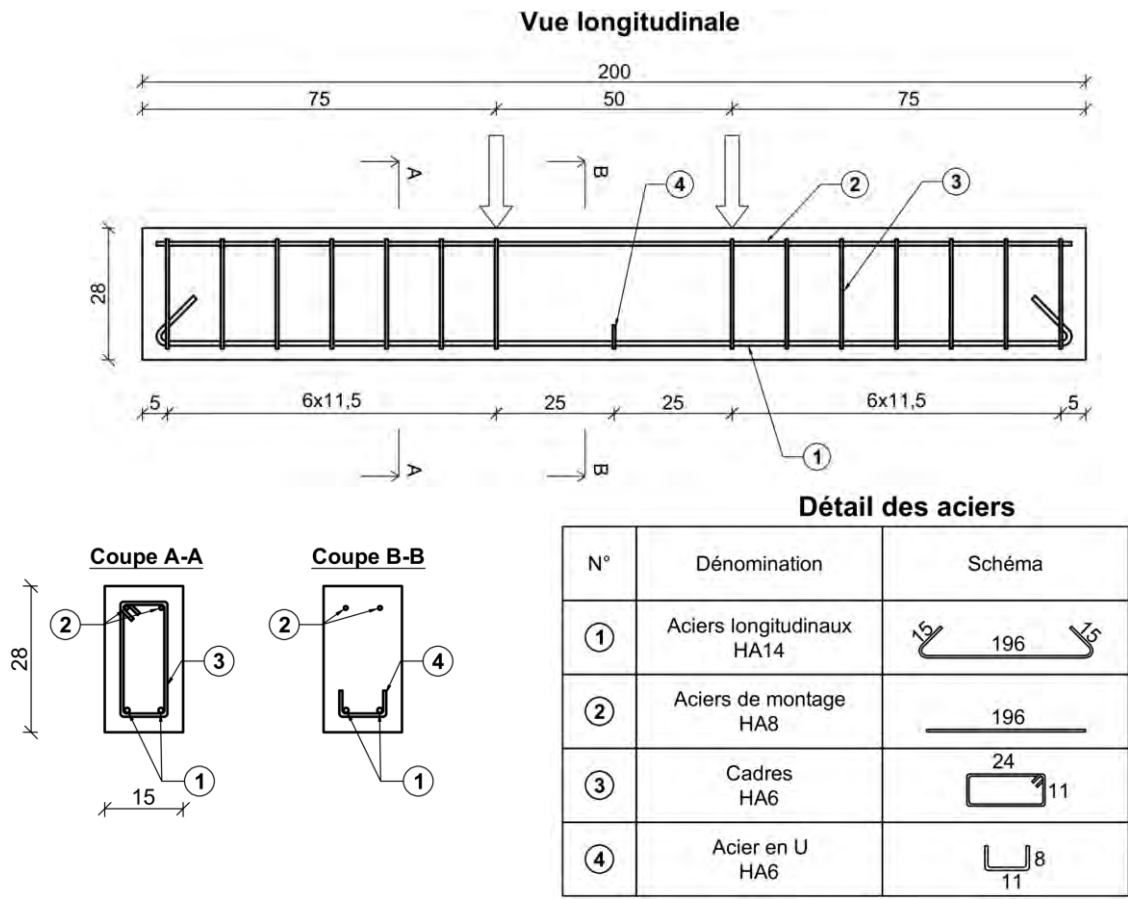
Plan de ferrailage de la configuration 1 (poutre P1)
